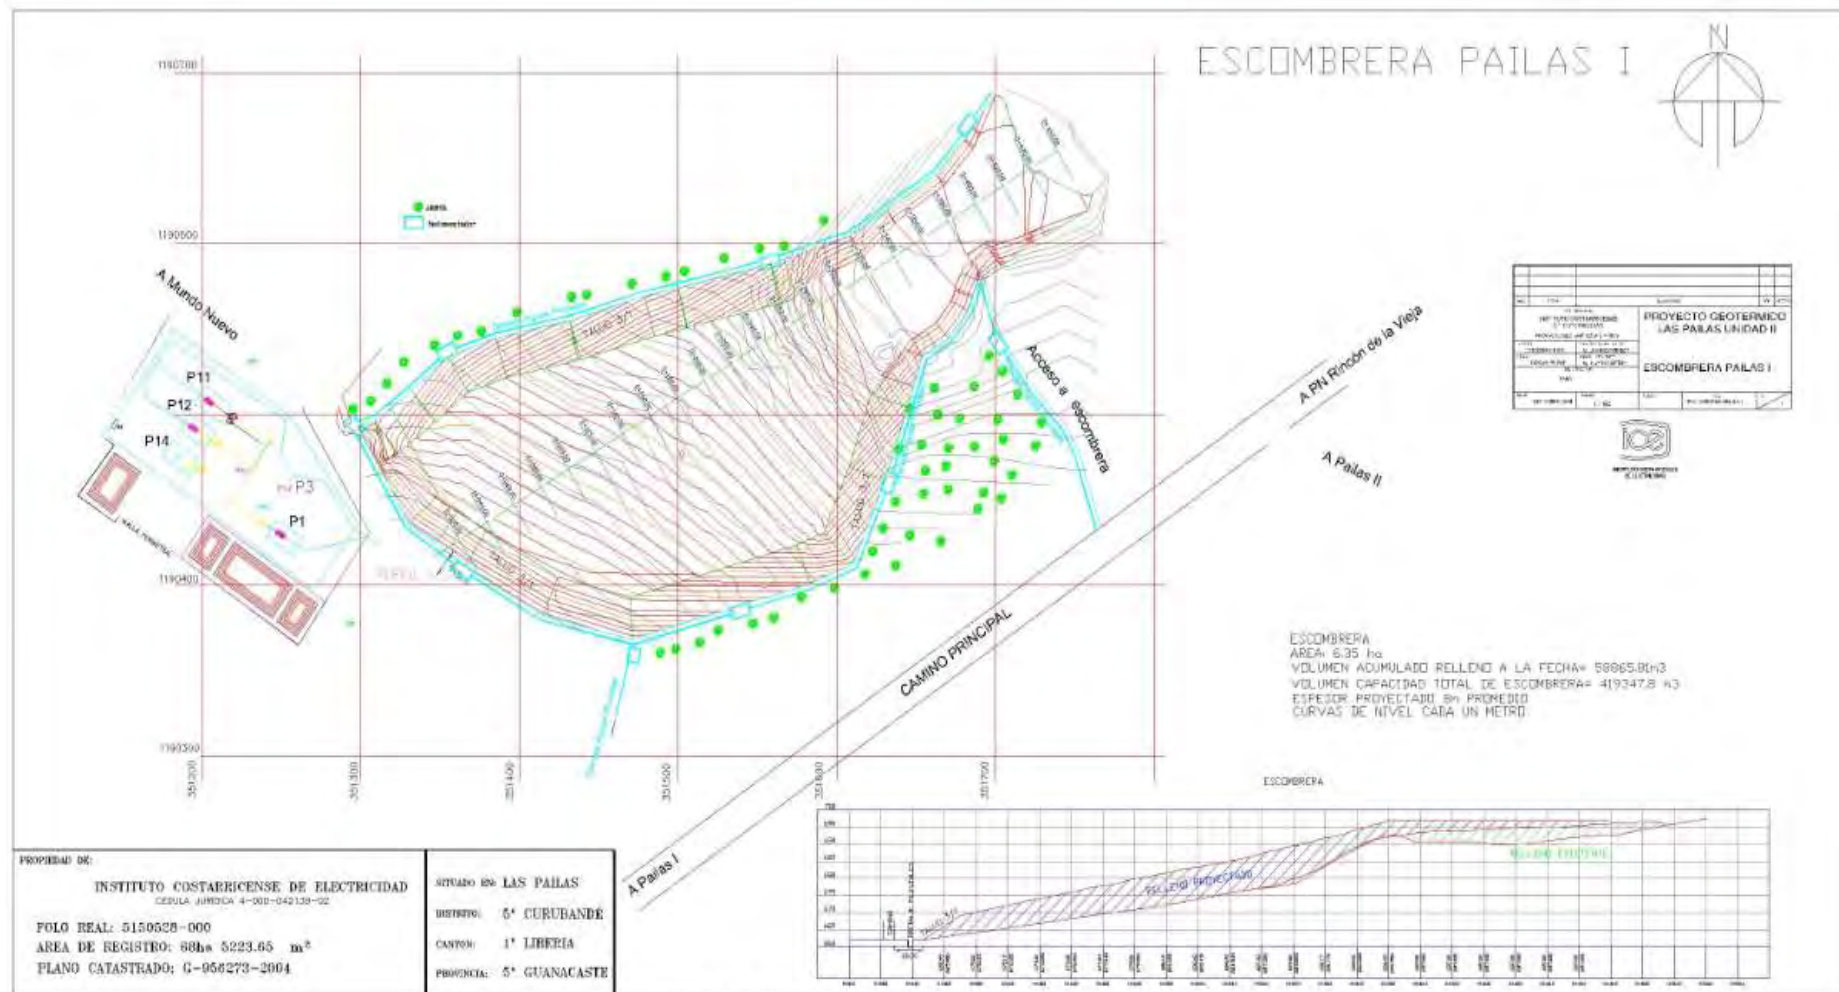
Plano Topográfico de la Escombrera Pailas I.
